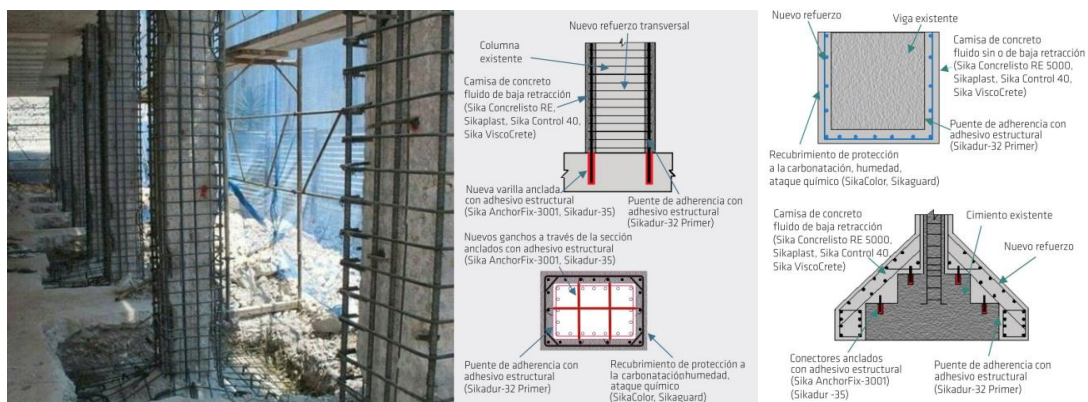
Reforzamiento de la estructura mediante encamisado y detalle de la conexión a la estructura existente. Tomado de: Sika Colombia S.A.S
